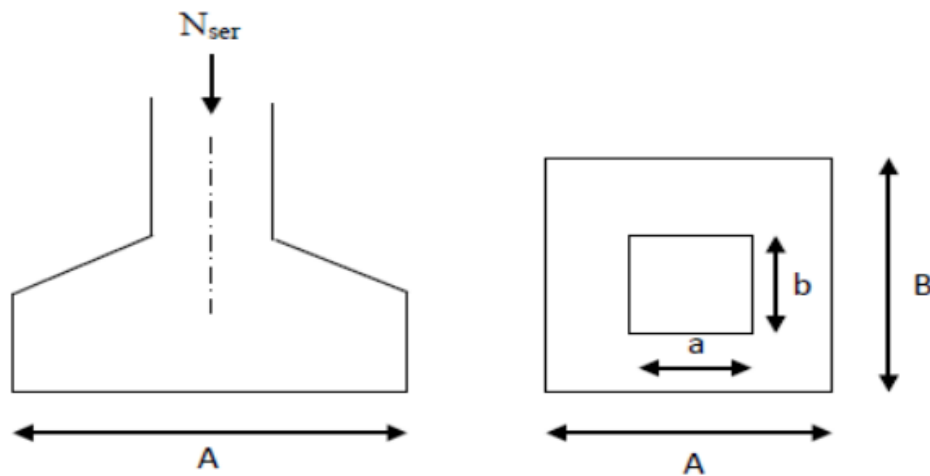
Schéma du dimensionnement d'une fondation.
